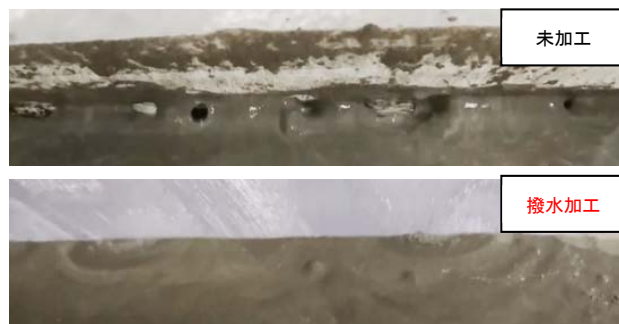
撥水加工の有無による脱泡状況（コンクリート）
